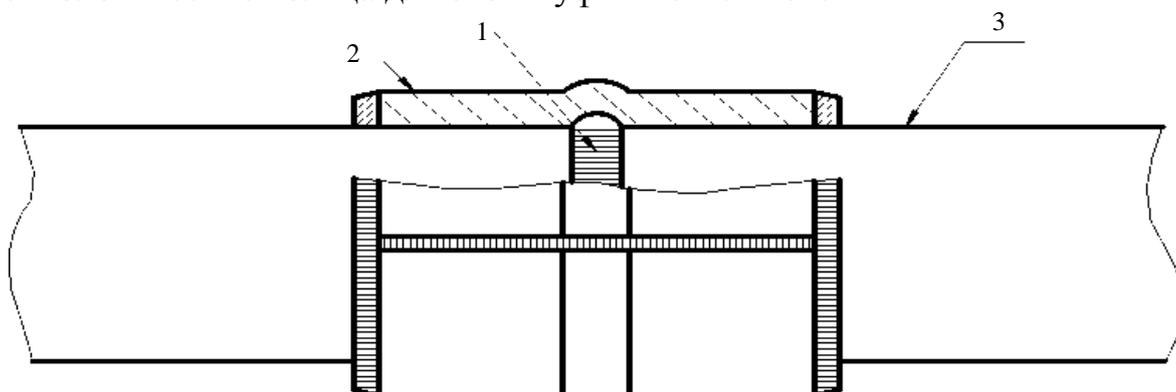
Муфта галтельная для ремонта сварных кольцевых швов (тип ПЗ): 1 – центральное кольцо с галтелью; 2 – дефектный сварной шов; 3 – труба
